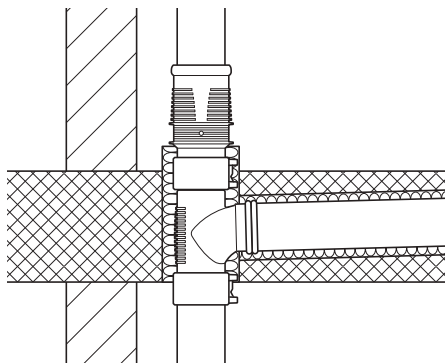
Likformigt grenrör 88,5°, betongingjutet
